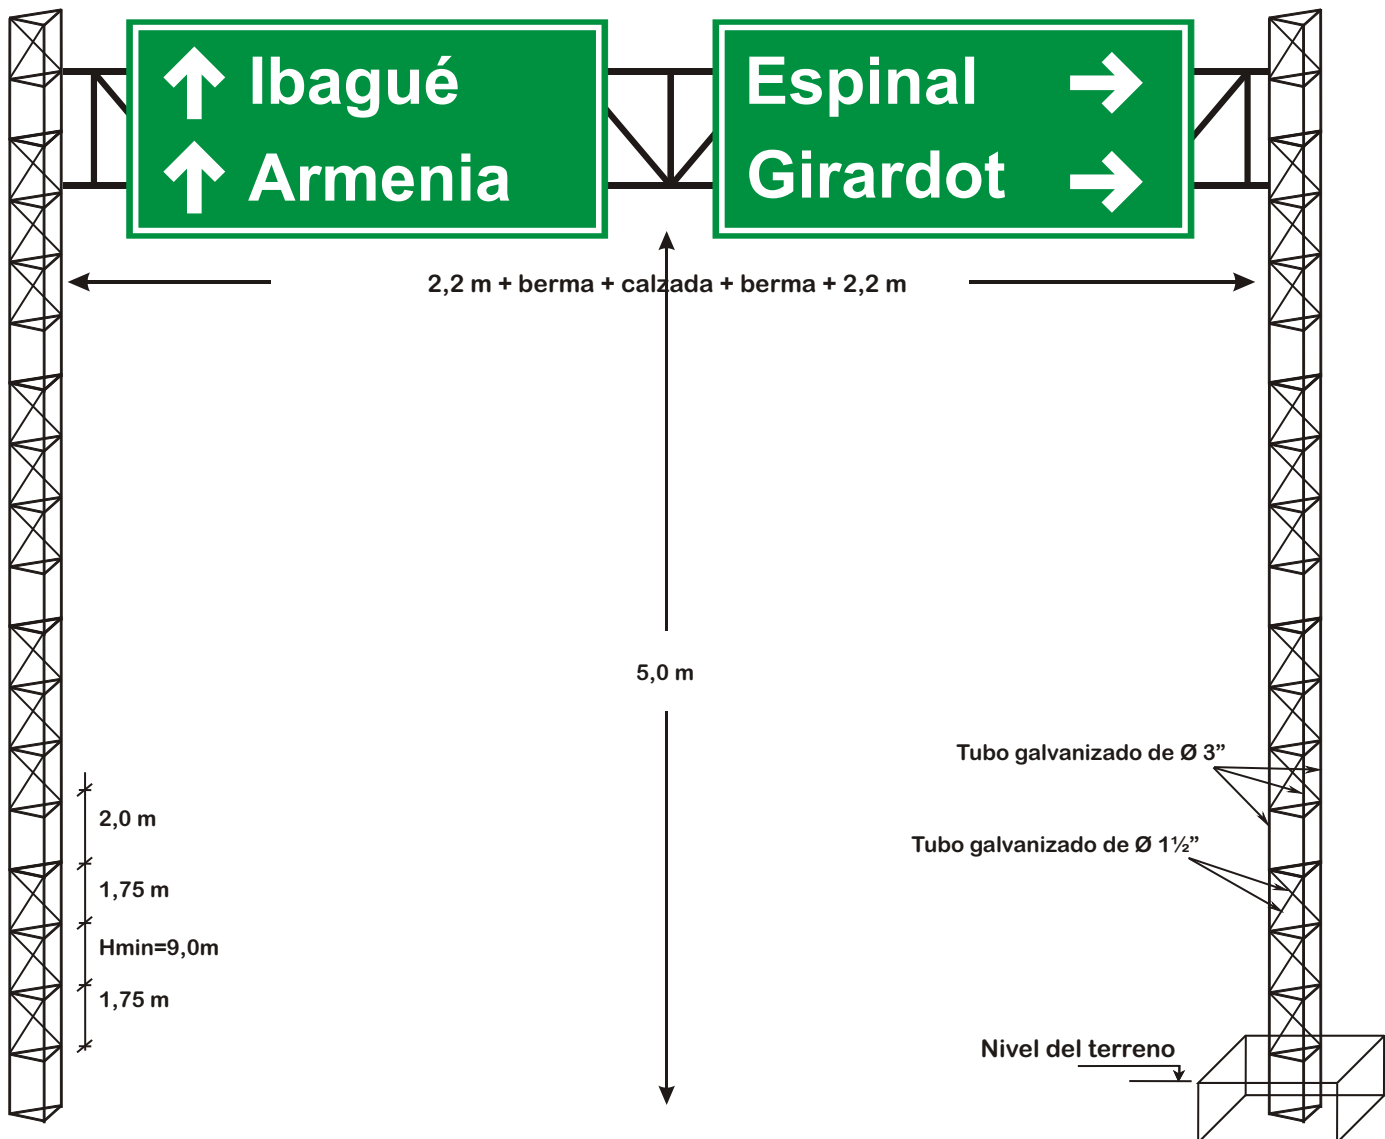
Señal elevada tipo doble bandera (Dimensiones en m)
